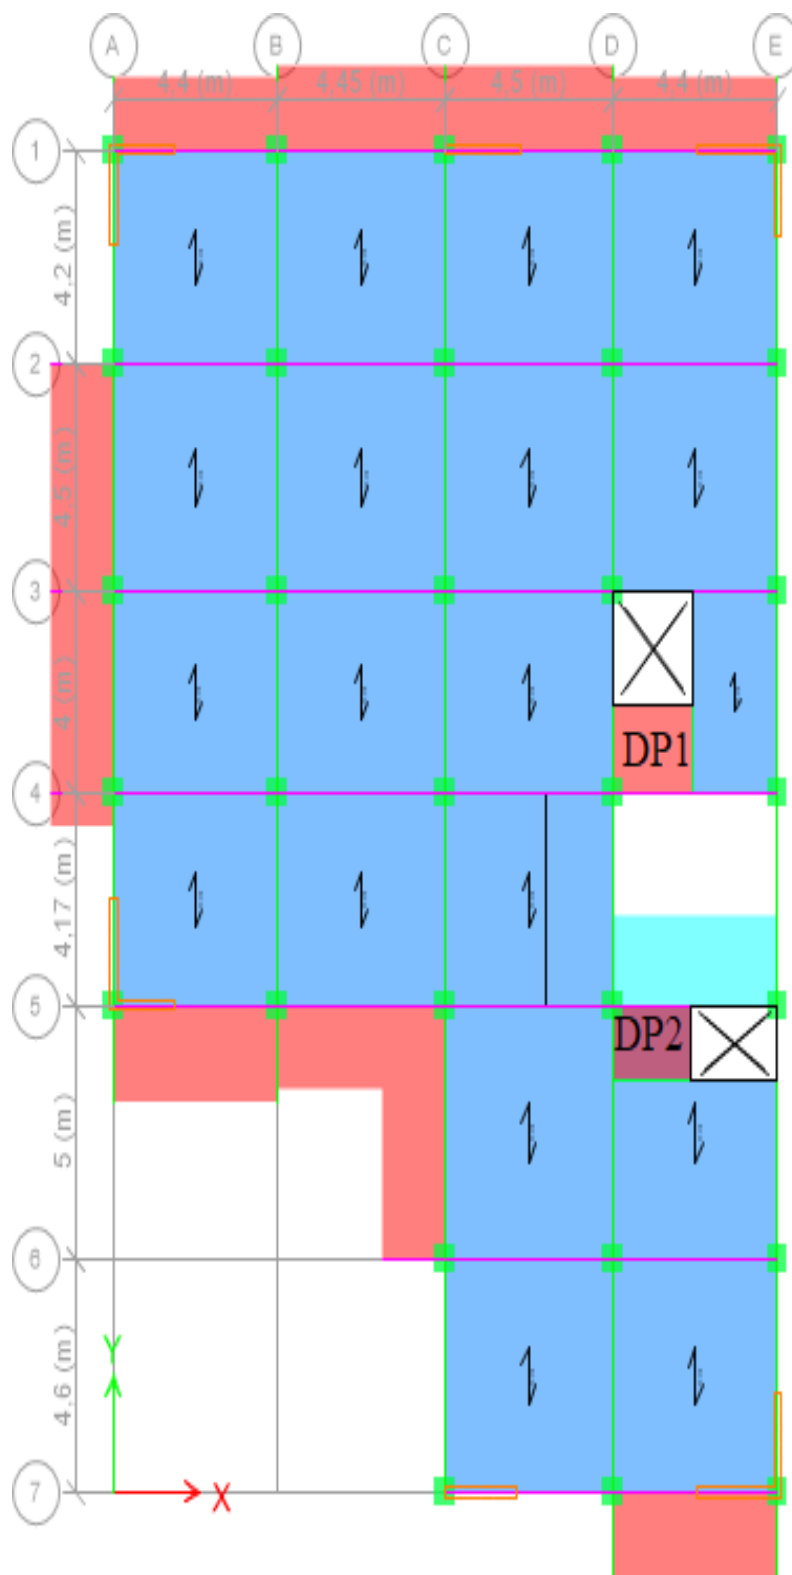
Disposition des poutrelles étages courant et terrasse.
